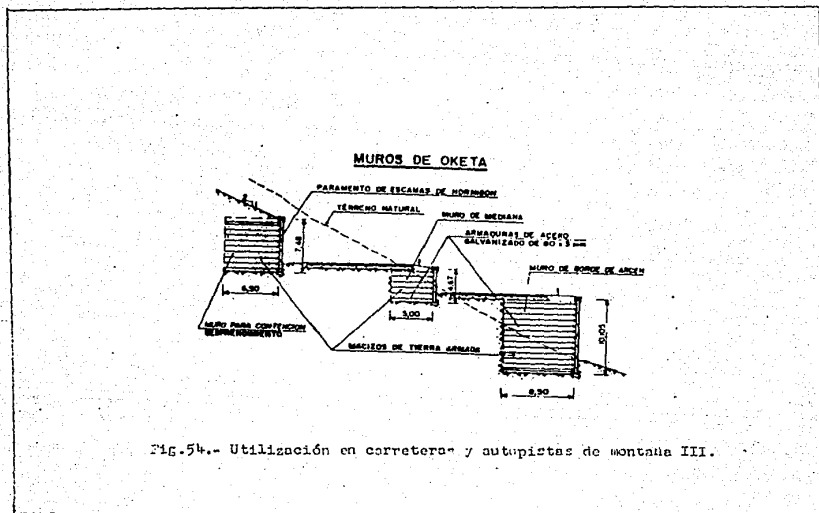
Utilización en carreteras y autopistas de montaña III.
